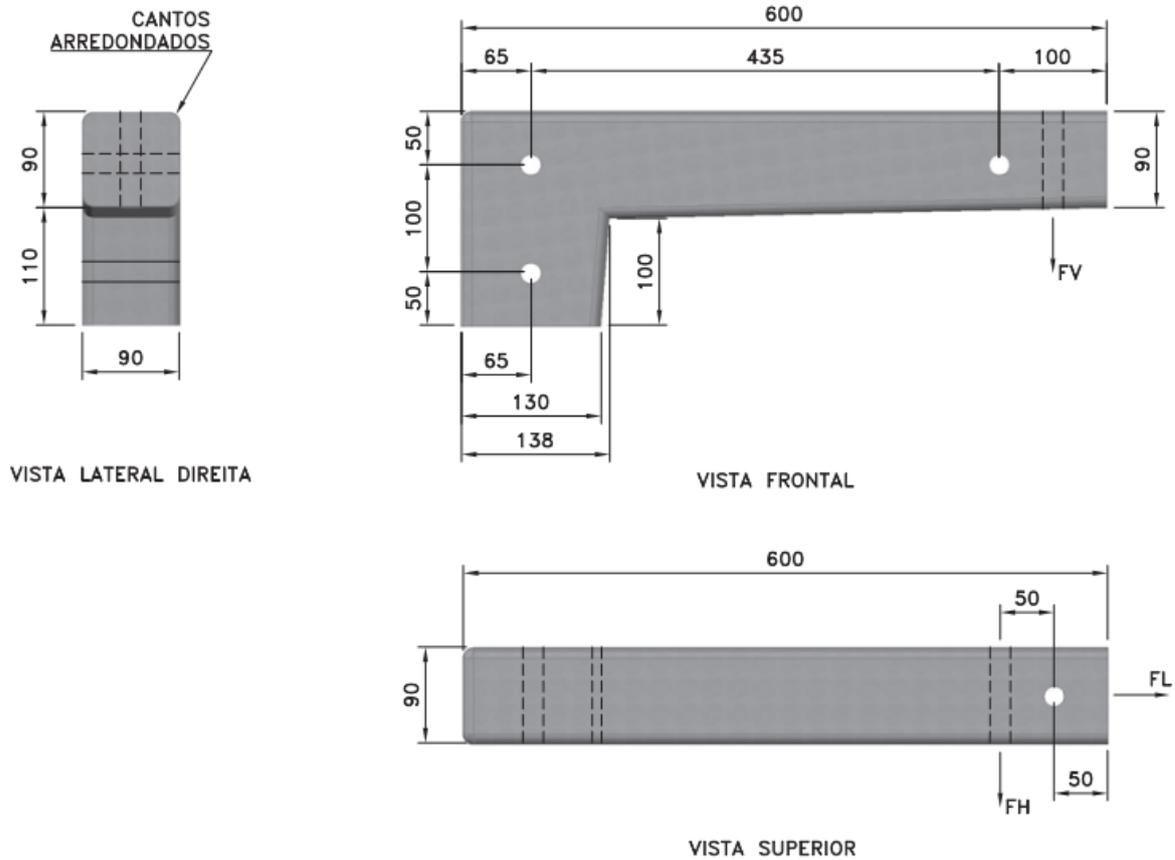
Cruzeta de concreto armado para MRT - tipo "L" – 600m
